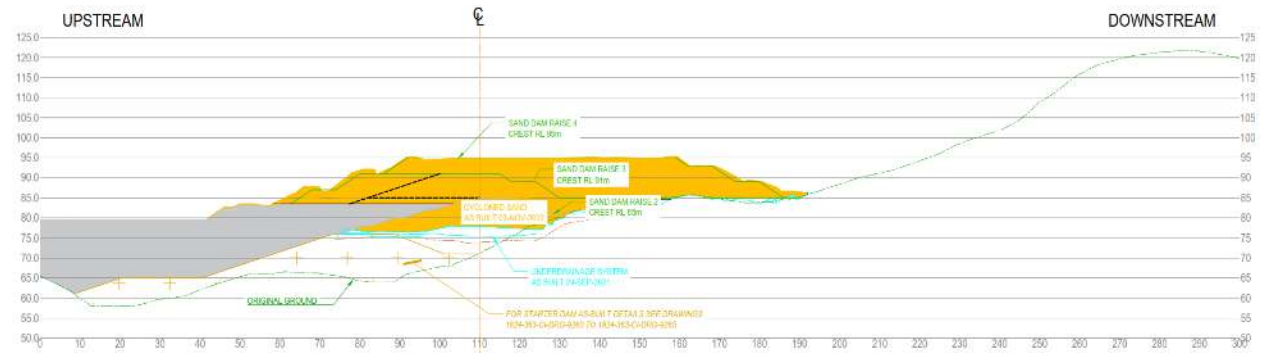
5: Sección de Presa Este As-Built a 4+400 – 03/noviembre/2022
